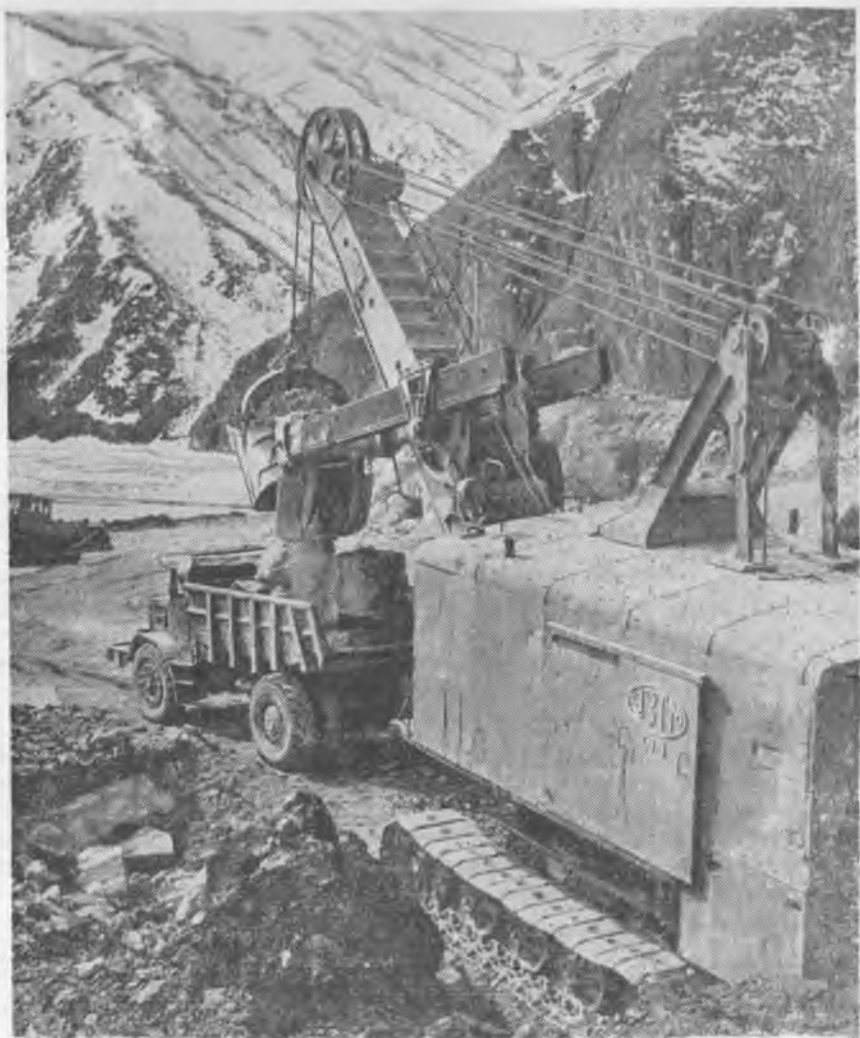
Выемка скального грунта на строительстве Бухтарминской ГЭС.
